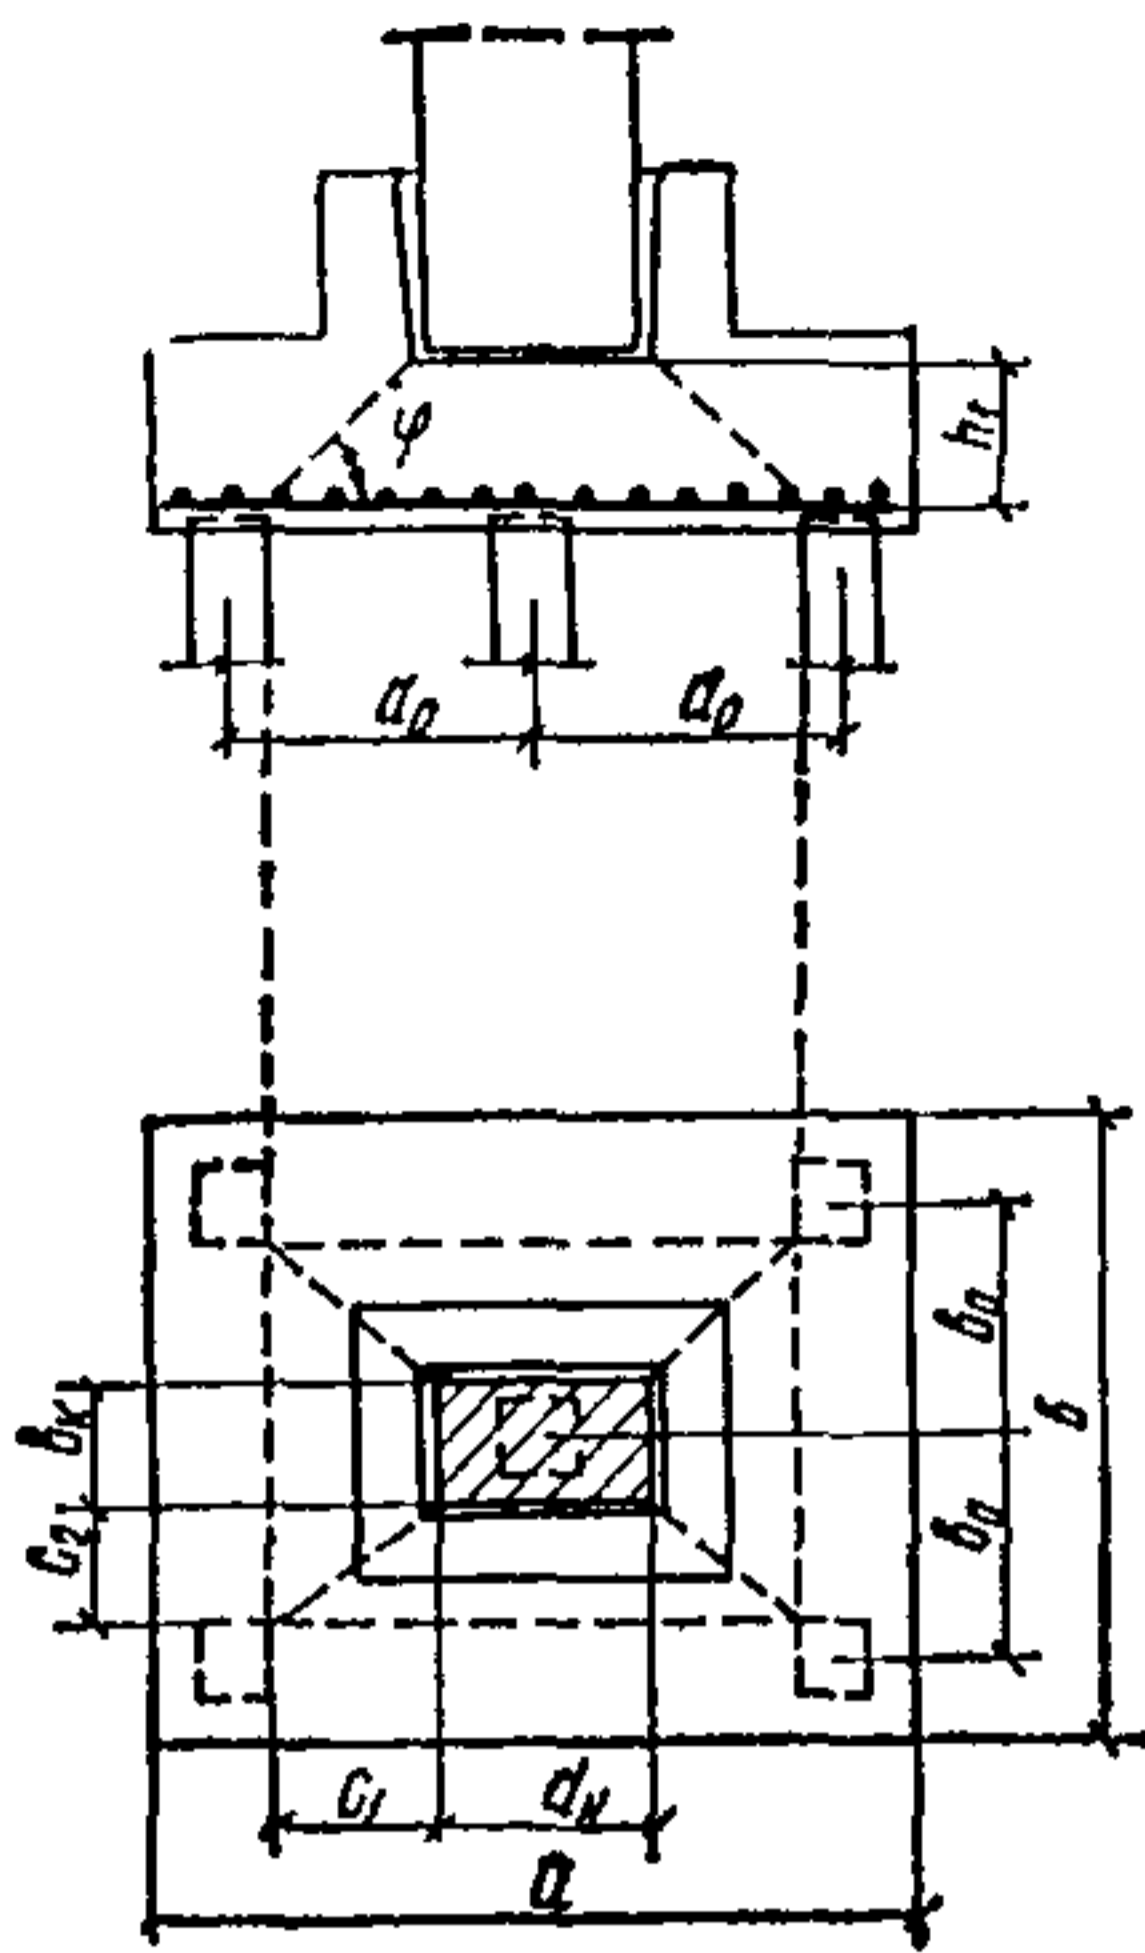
Схема образования пирамиды продавливания под сборной железобетонной колонной прямоугольного сечения
